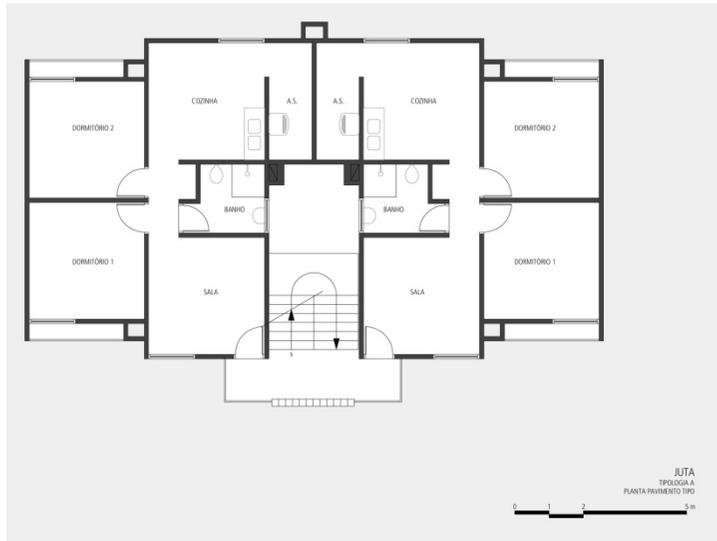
Tipologia planta baixa tipo A – Conj. União da Juta.
